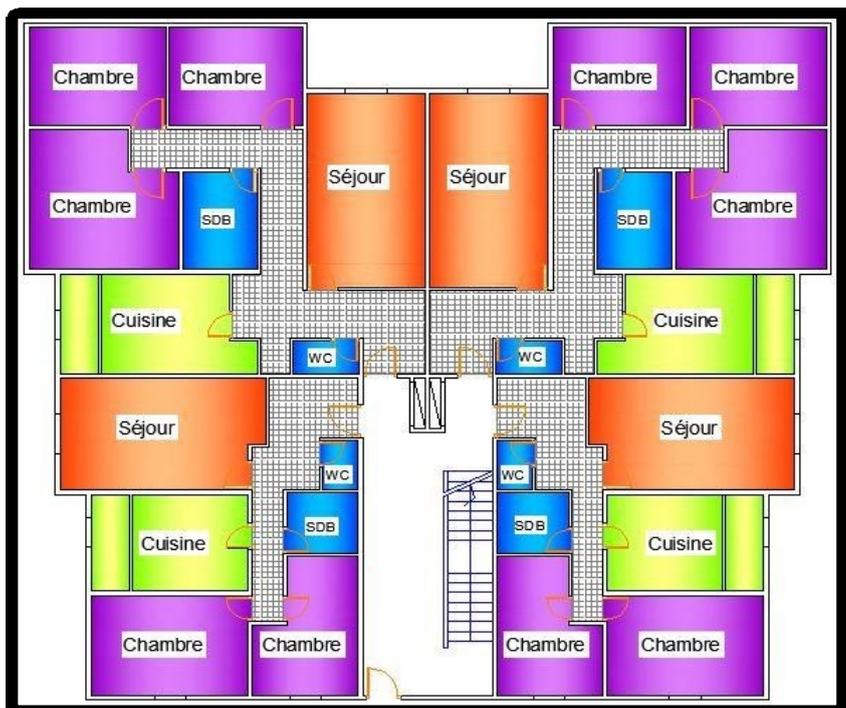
Plan d'étage courant d'un bâtiment type B Source : l'auteur.
